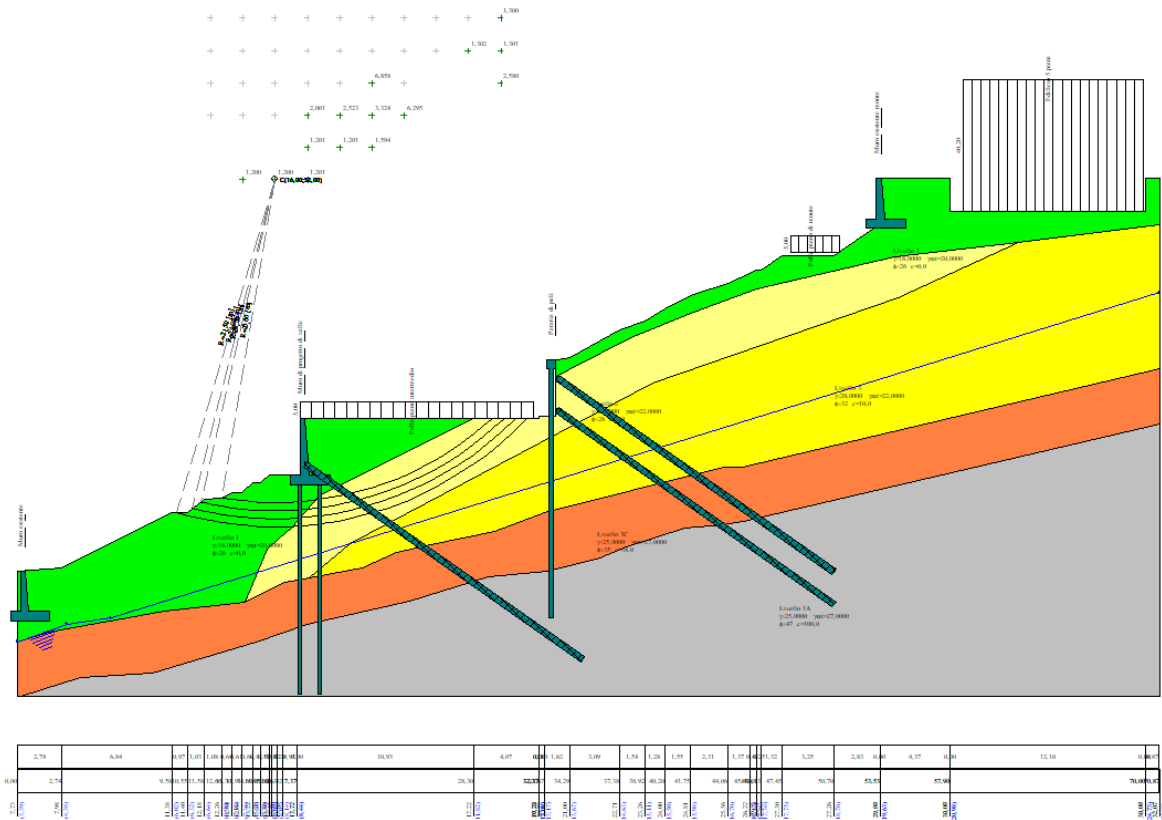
Sezione 10 stato di progetto. FS minimo 1.200
